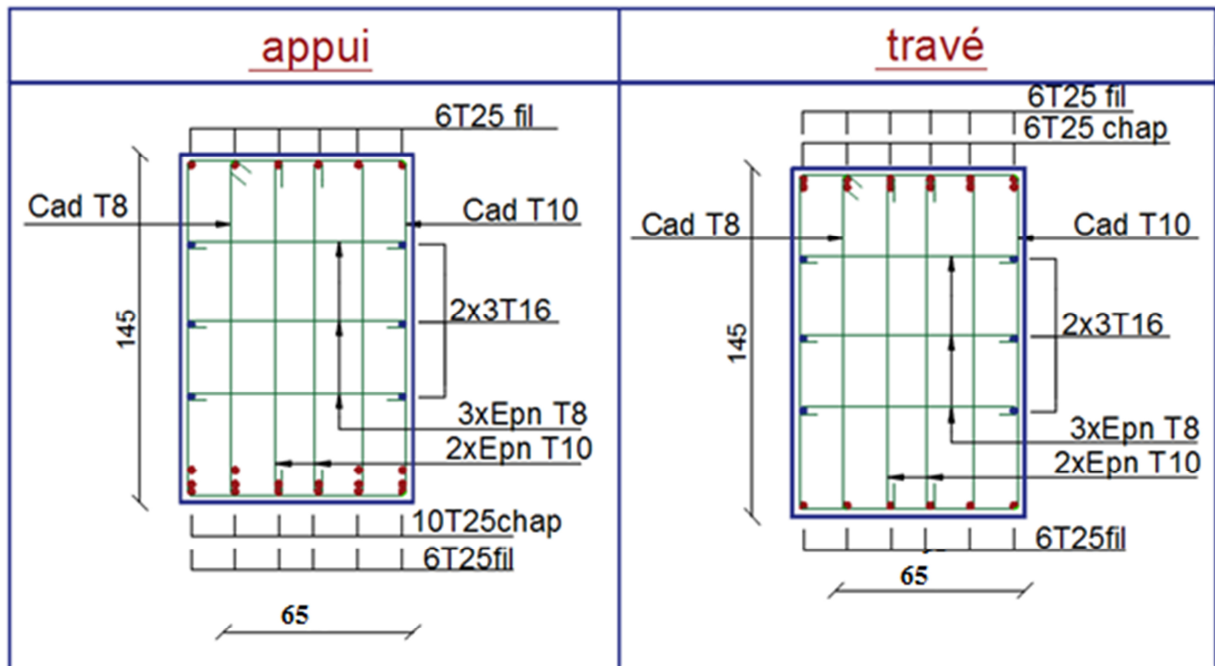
Ferraillage des poutres nervures sens longitudinale.
